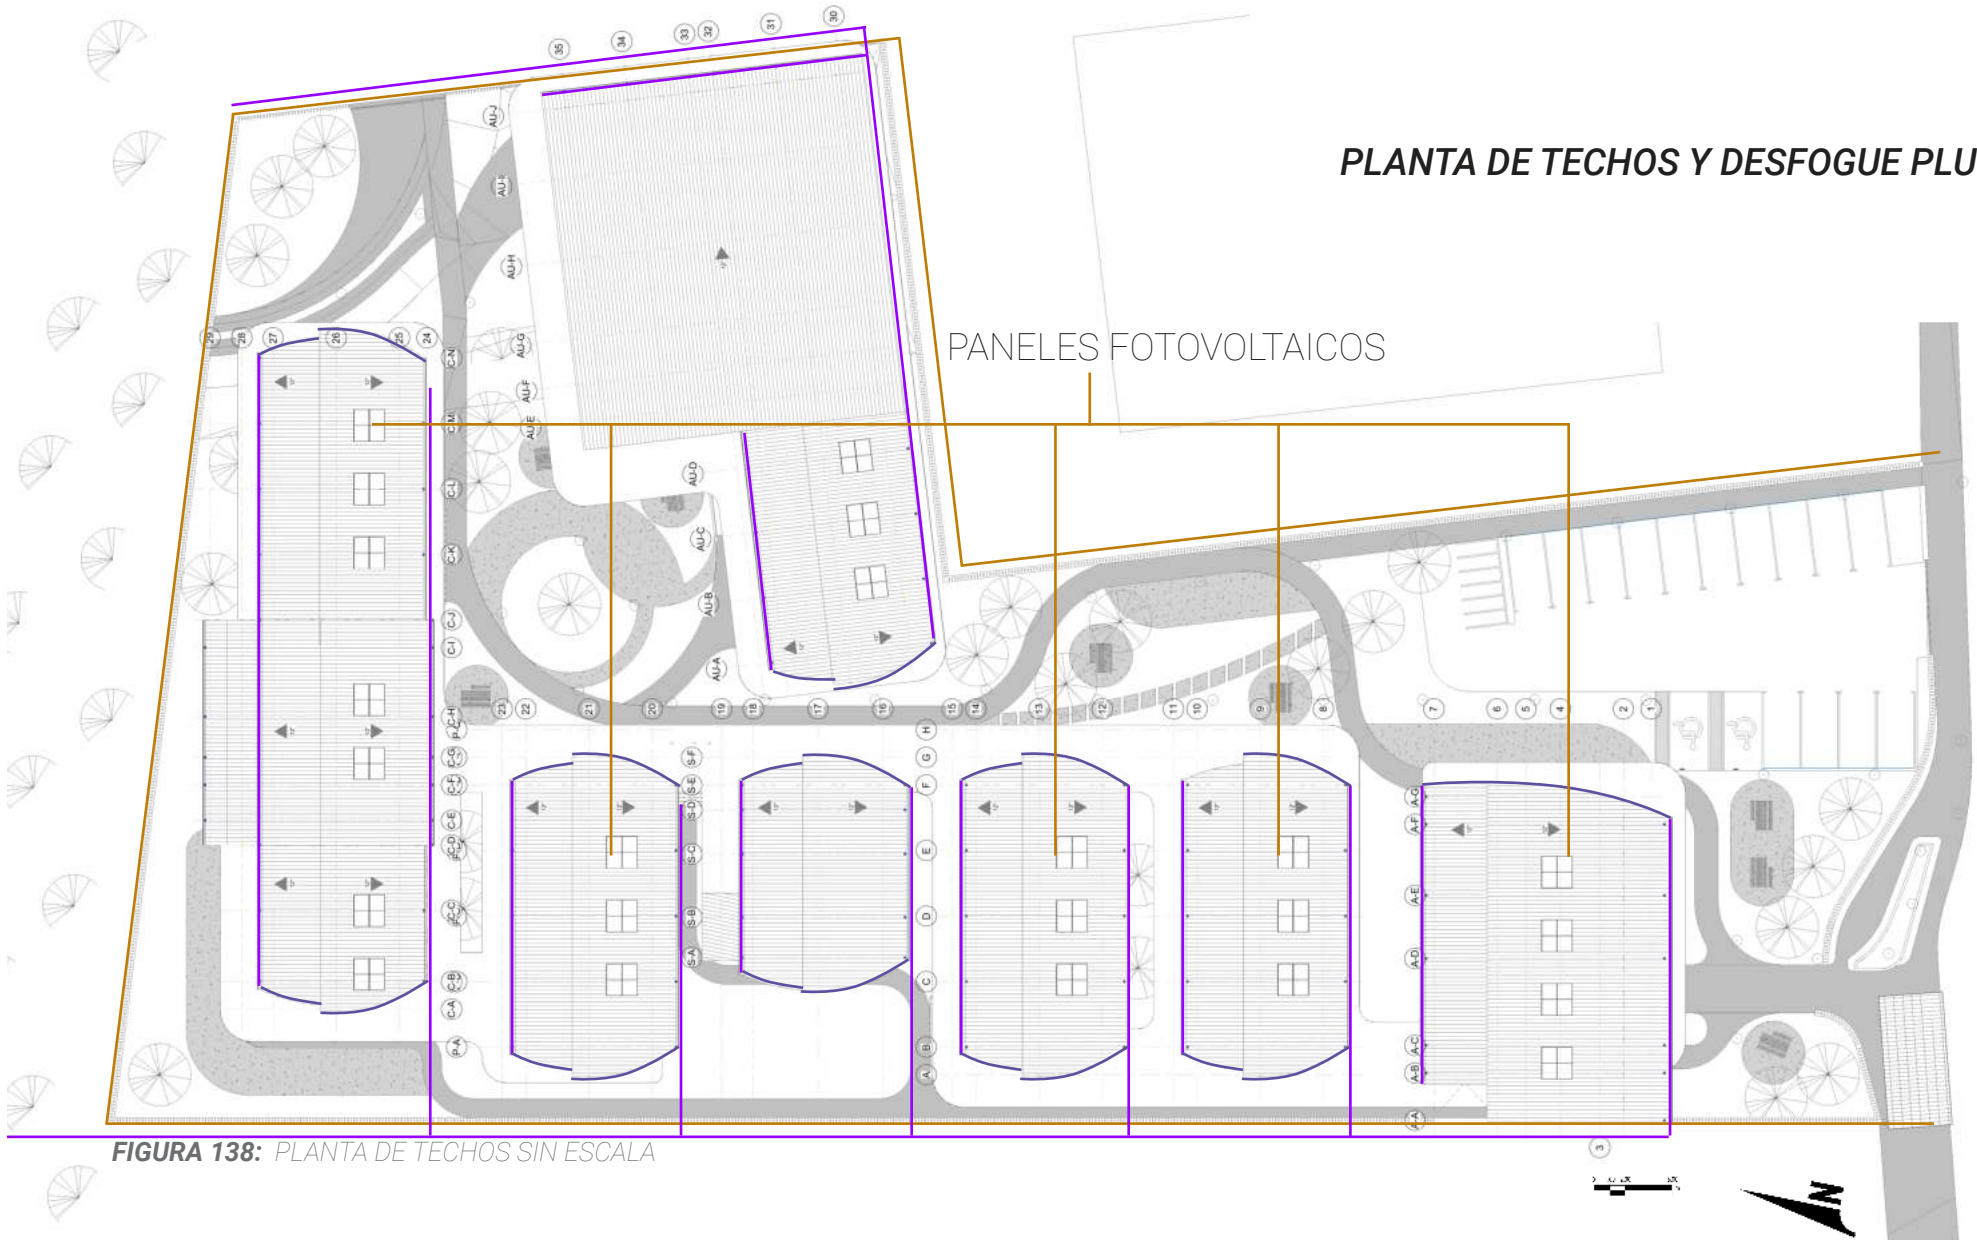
PLANTA DE TECHOS SIN ESCALA
